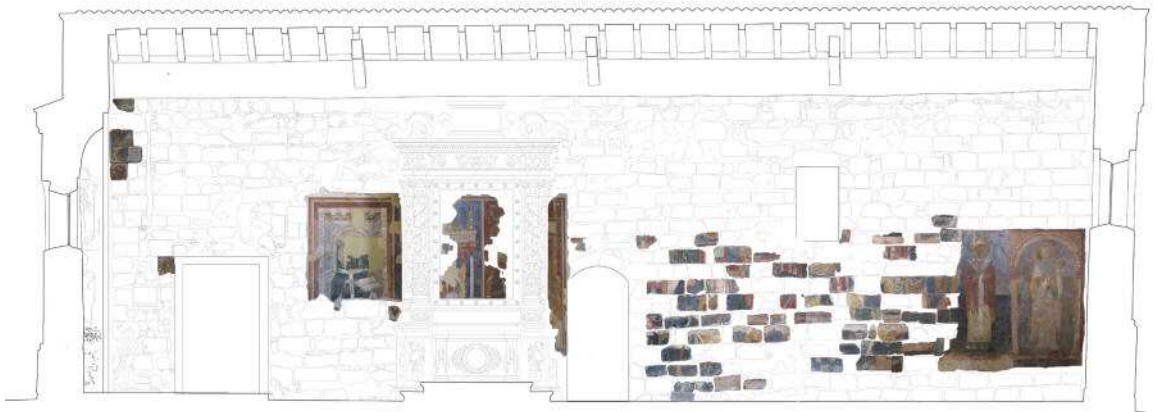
Parete laterale della navata destra. Fotopiano degli affreschi sul rilievo della parete.
